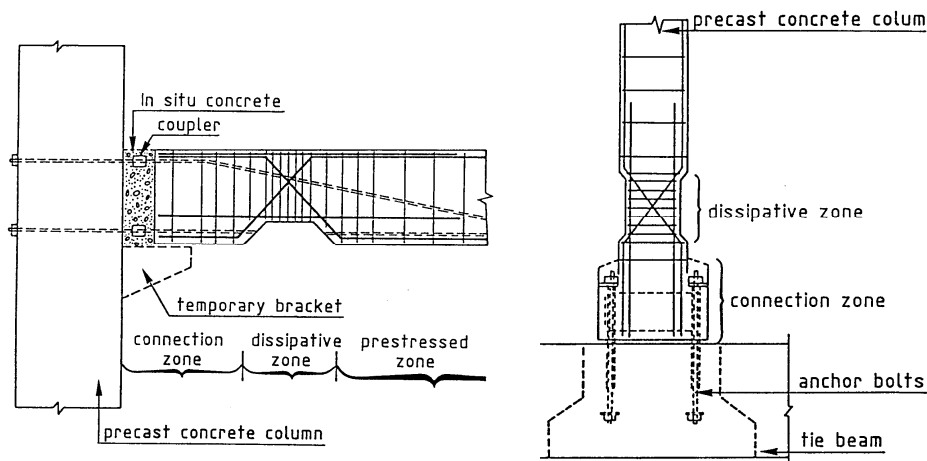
Zone dissipative provoquée. A gauche en bout de poutre. A droite en pied de poteau.
